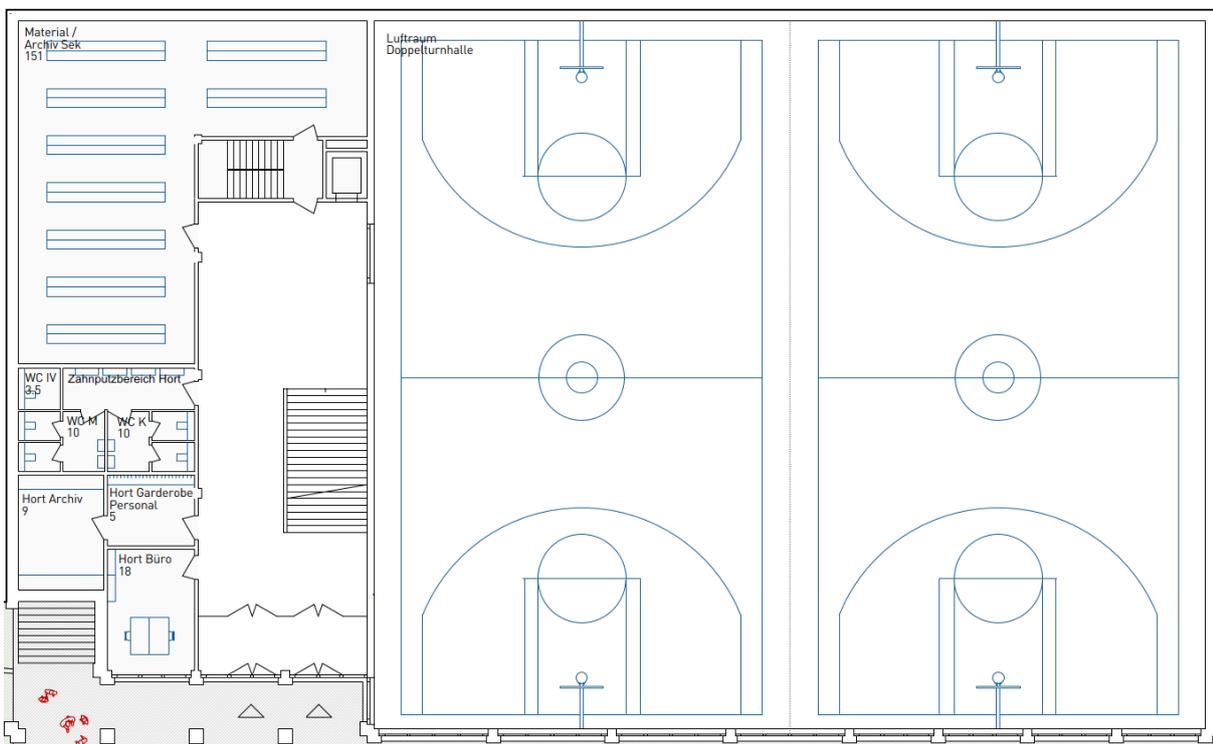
Grundriss Eingangsgeschoss Sekundarschule
